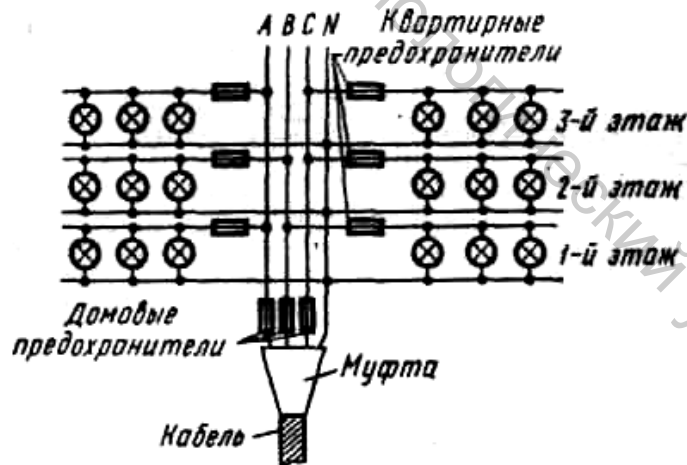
Четырехпроводная осветительная сеть жилого дома
